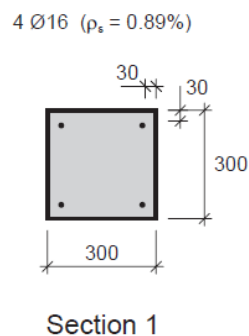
Sección de hormigón armado calculado. Fib Bulletin N°46. [45]
